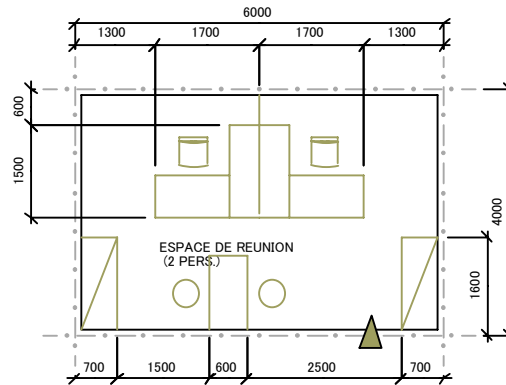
Plan planimétrique du bureau de nettoyage et d'hygiène
